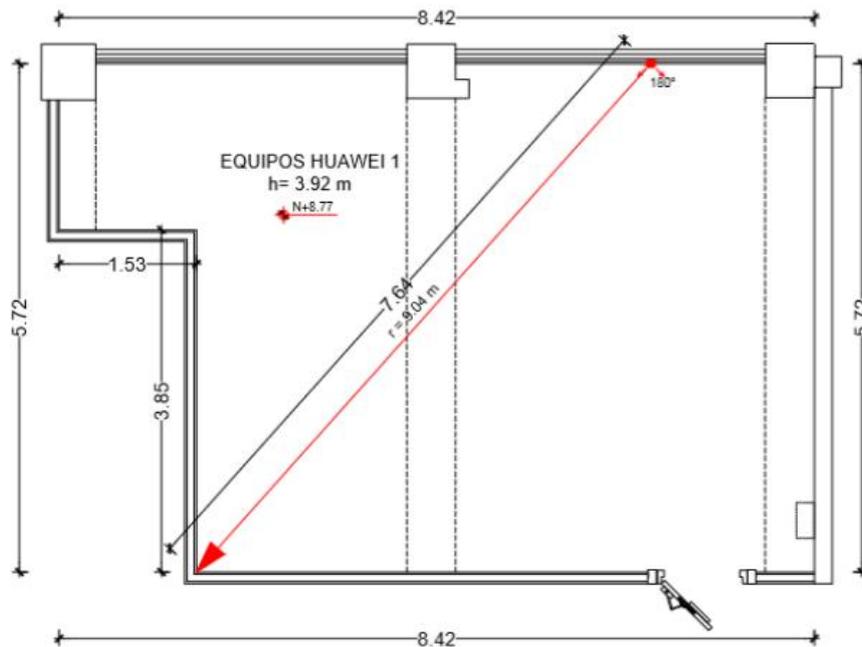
Plano de ubicación de tanque de agente limpio, tuberías y toberas de sala Huawei nivel 1
